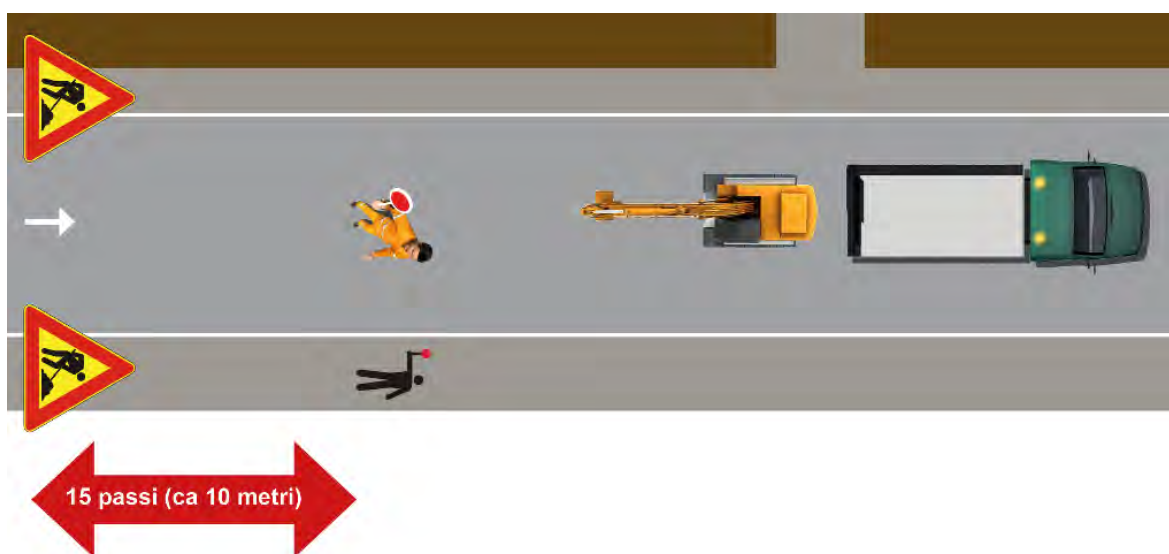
schema del cantiere stradale durante la fase di scarico dei mezzi
